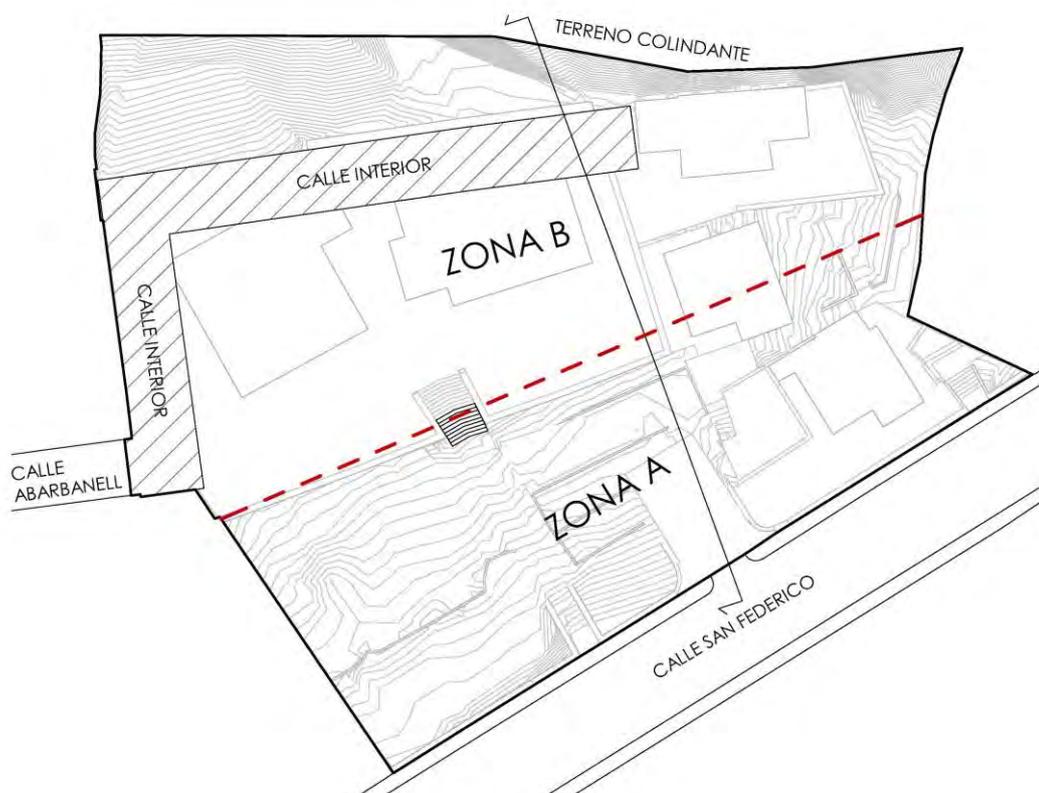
Plano de Emplazamiento de parcela indicando Zonas A, B y Calle Interior
